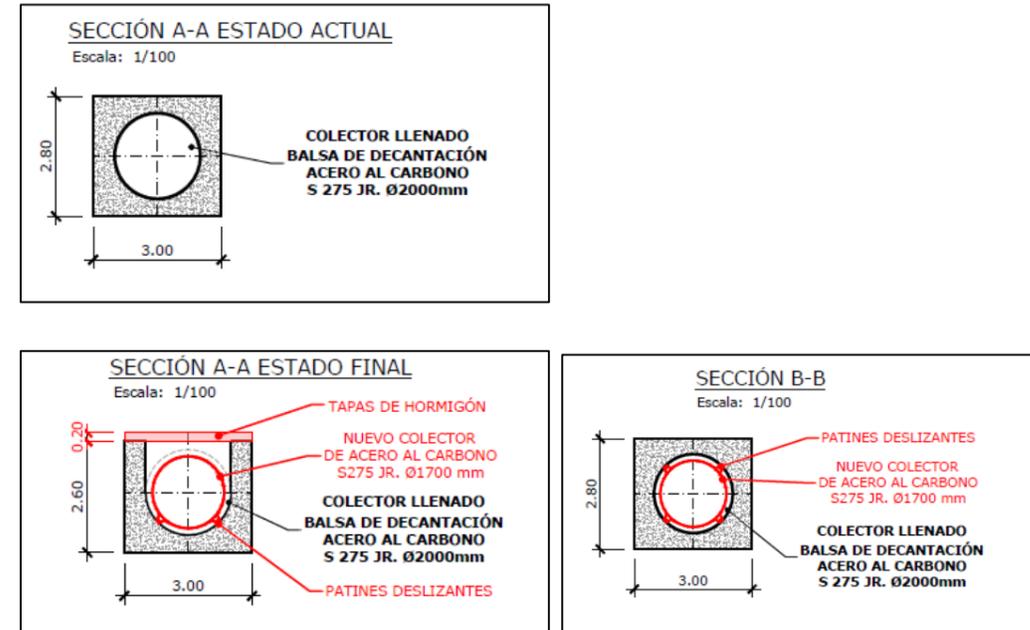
Secciones tipo del colector de fondo . Estado actual y estado proyectado, mediante nueva camisa de acero interior
